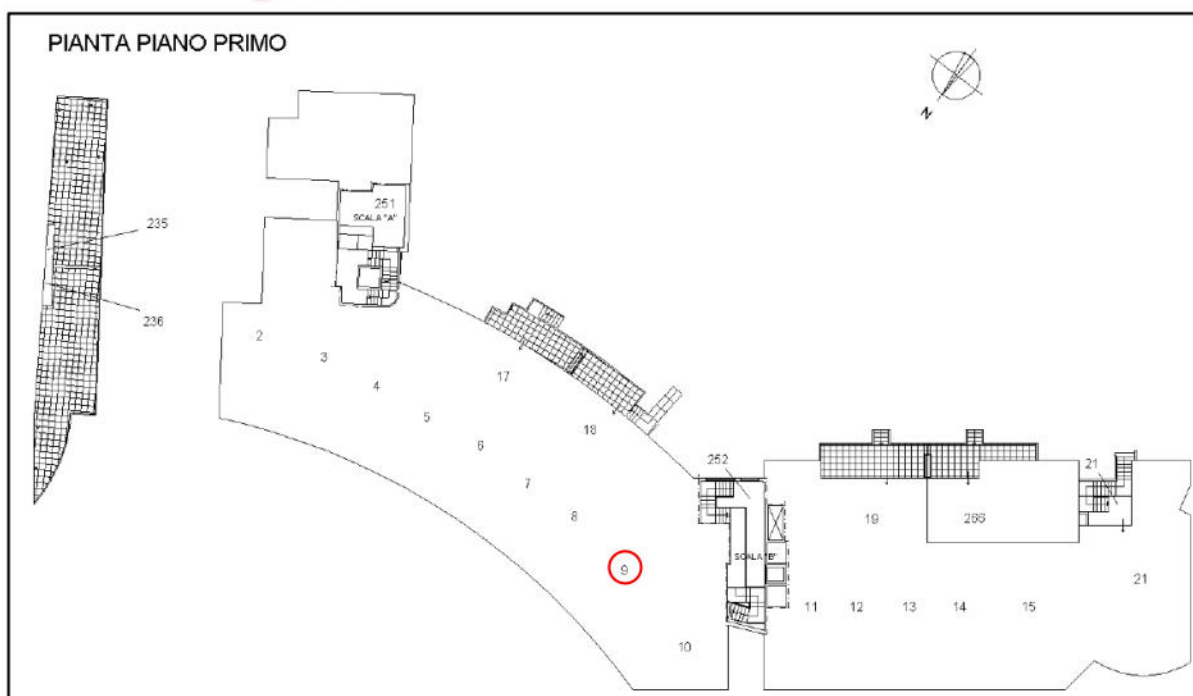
Estratto dell'elaborato planimetrico (Catasto Fabbricati)
